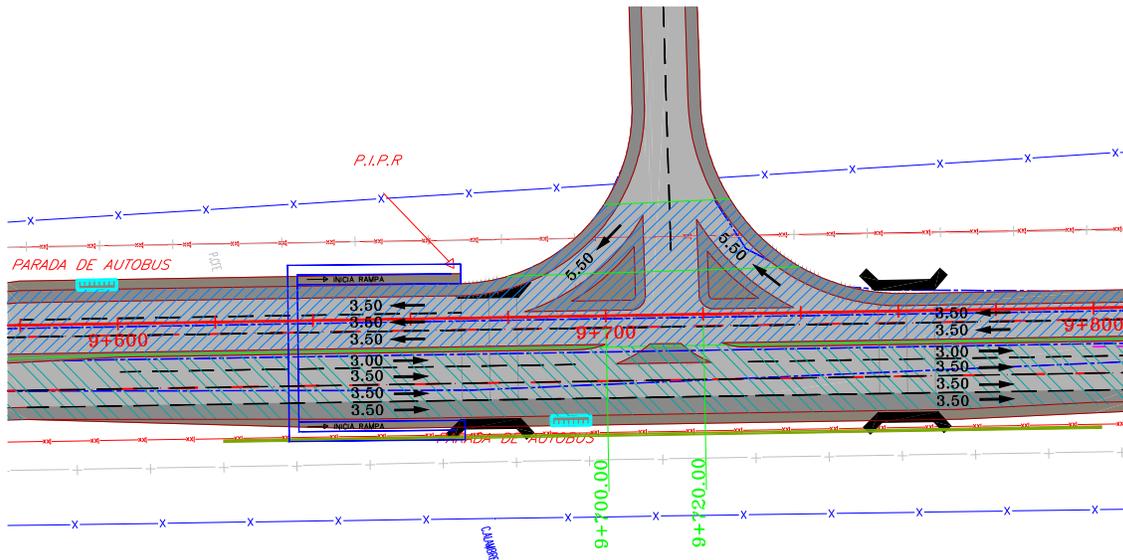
Plano de planta Proyecto Entronque “Los Pozos”
